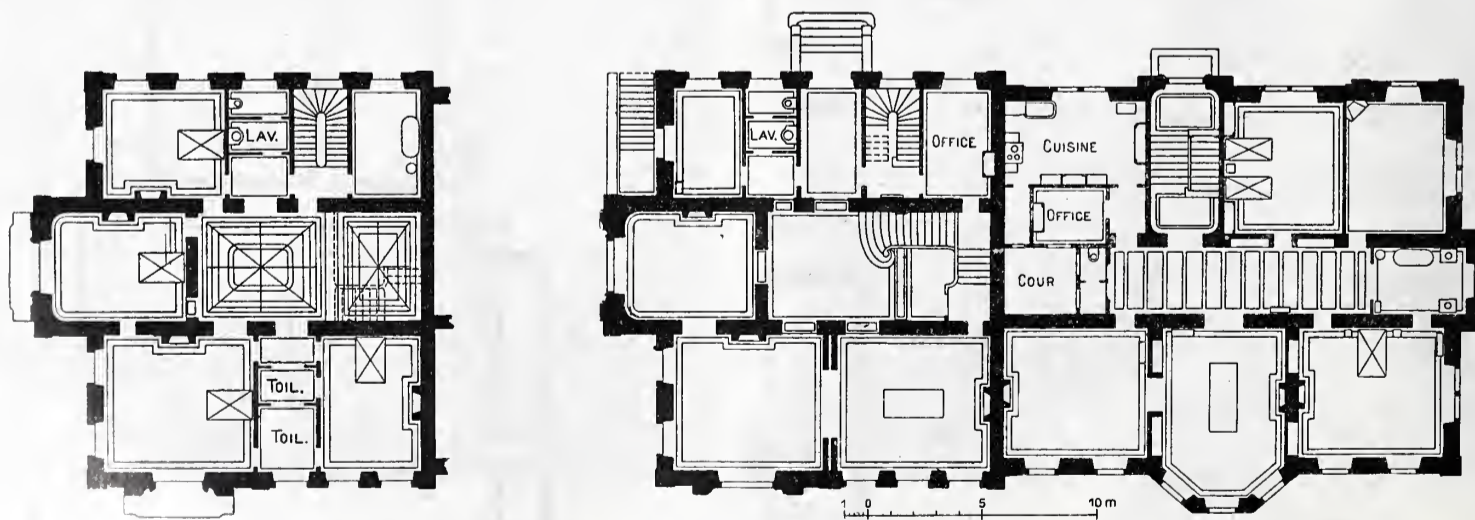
et 12. Pavillons d'habitation. — Plan du rez-de-chaussée et plan du premier étage de l'aile ouest.
